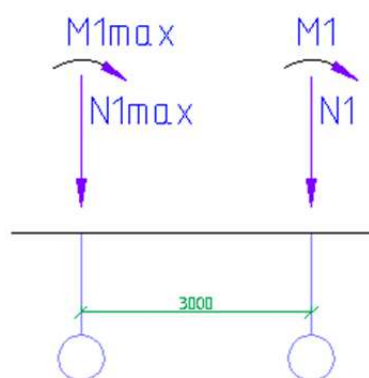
Схема приложения нагрузки от ветвей продольной рамы
